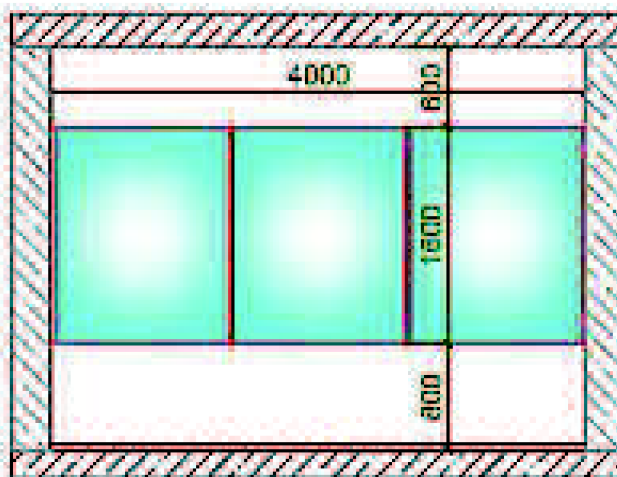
Půdorys 2.NP až 4.NP s variantami zasklení
